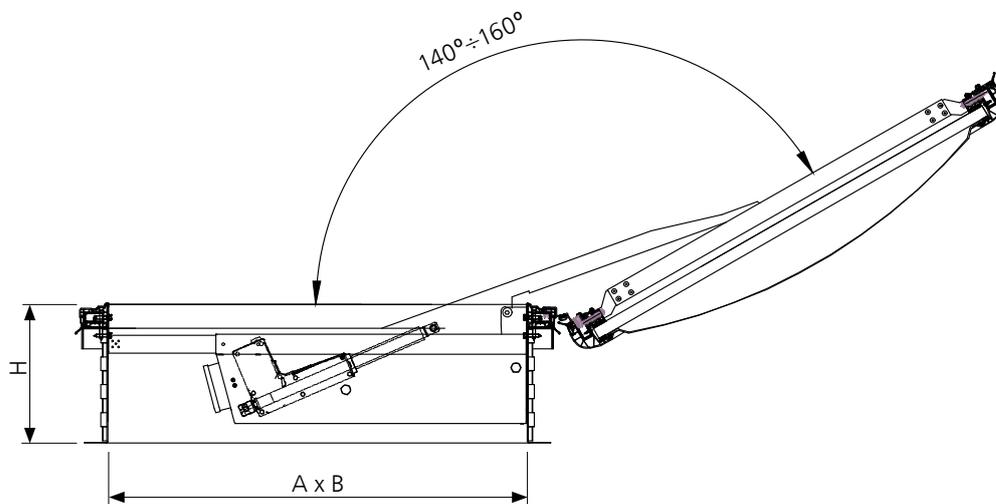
Aufbau eines RWA-Gerätes mcr ULTRA THERM Typ E mit geradem Stahl-Aufsatzkranz in Dachausstiegsausführung mit zwei elektrischen Antrieben
